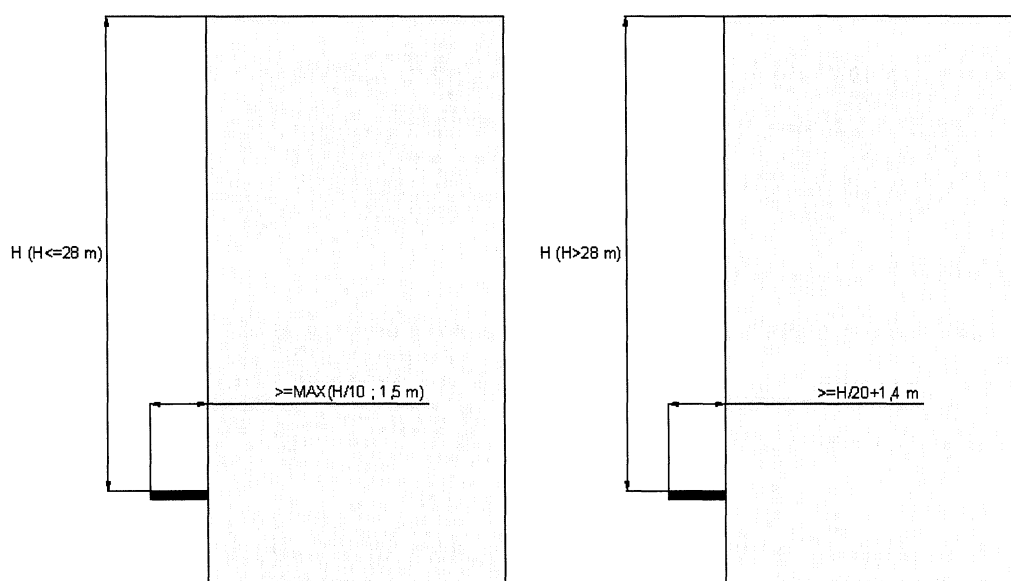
Ilustração do comprimento de palas ou varandas
